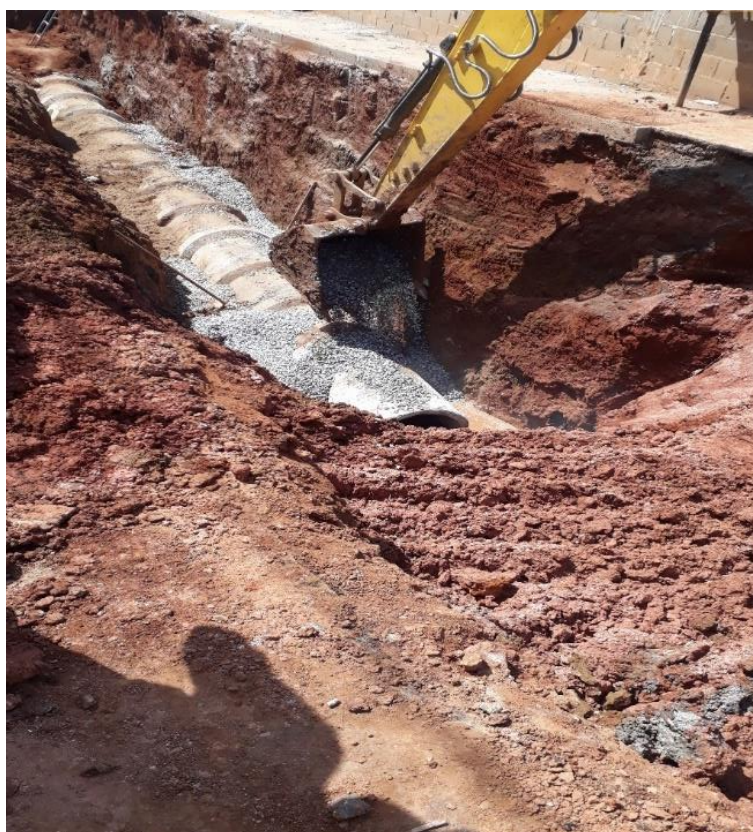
Rejuntamento dos encontros dos tubos de concreto
